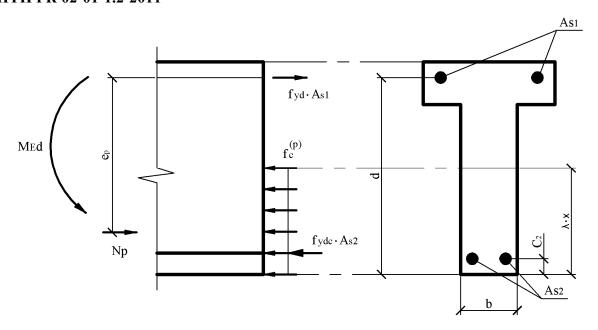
Схема усилий в поперечном сечении железобетонного элемента с прямоугольной сжатой зоной в стадии предварительного обжатия
